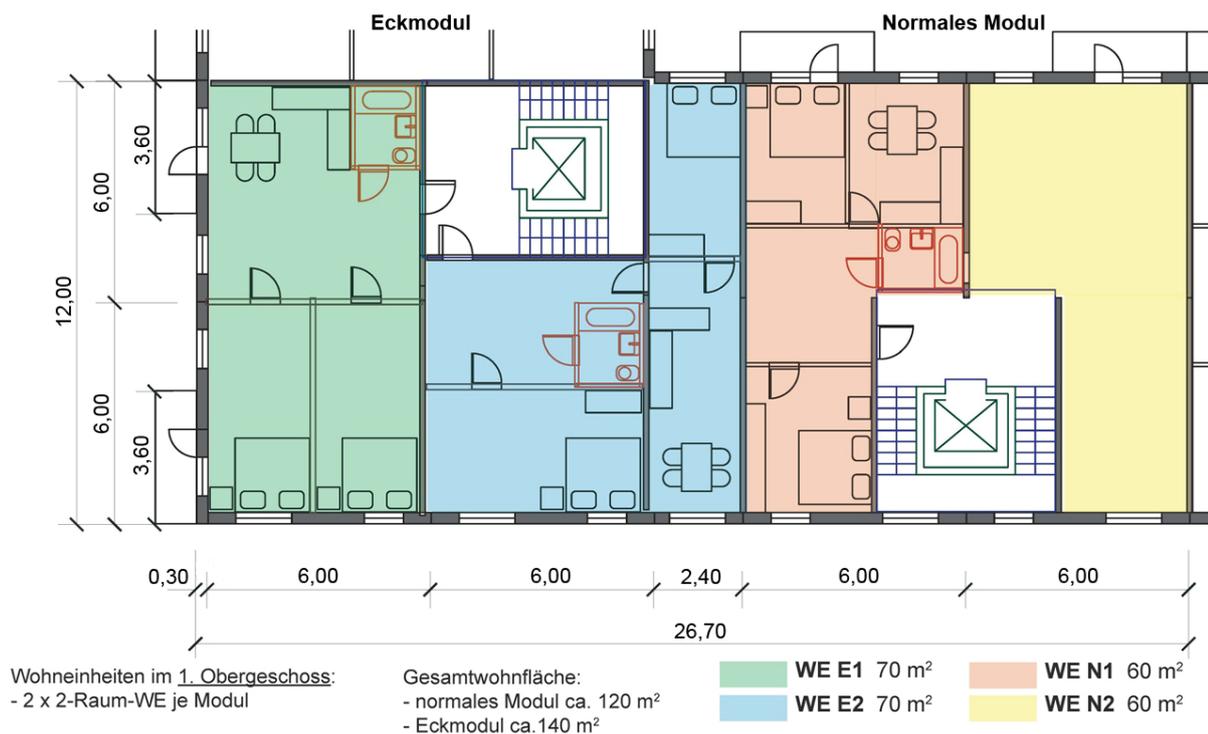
Grundriss 1. Obergeschoss, Ausschnitt (M 1:200)
